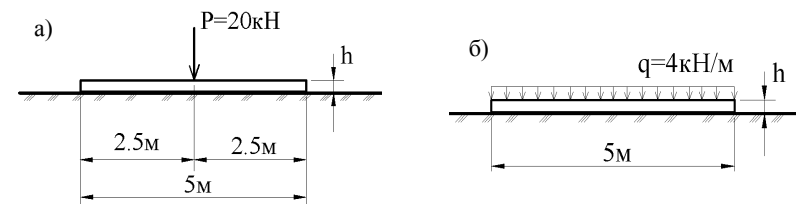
Розрахункові схеми балок на ґрунтовій основі:
